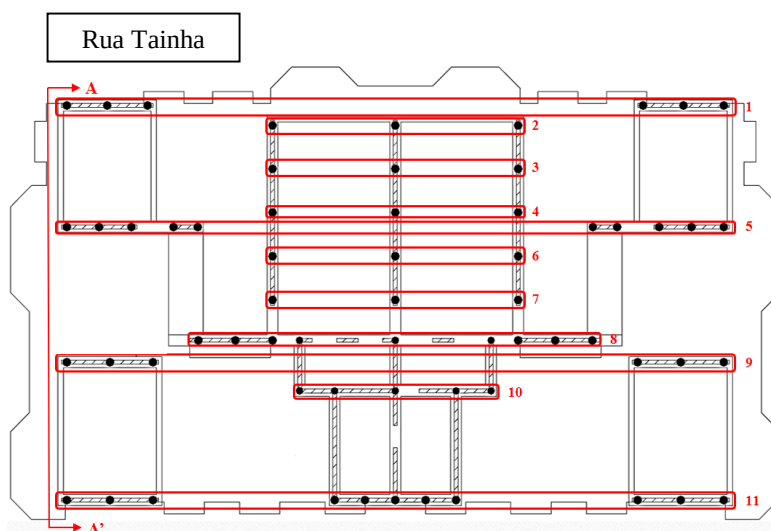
Planta baixa com estacas, vigas-baldrame e pilares-parede.
